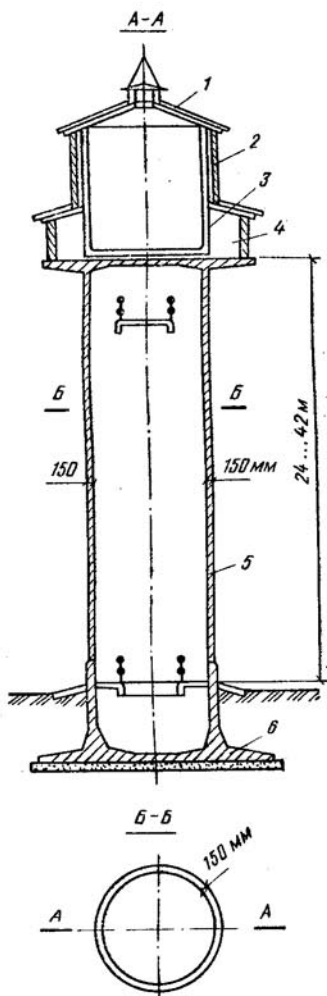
Водонапорная башня с монолитной сплошной железобетонной опорой
